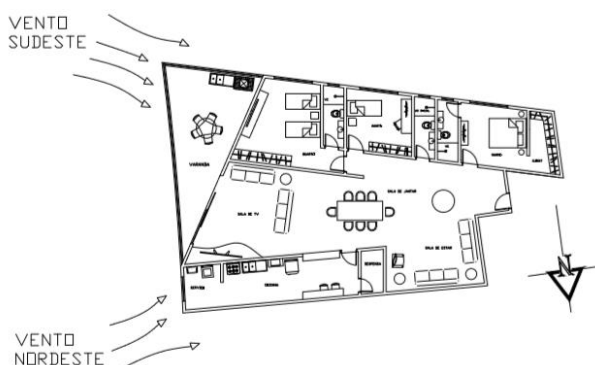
Planta baixa do apartamento tipo 2. Fonte: elaborado pelos autores.
